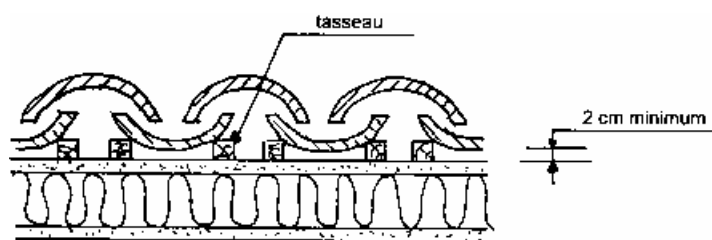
Fixations des plaques FLEXOUTUILE par pointes PTM (exemple 5 fixations par rangées)
